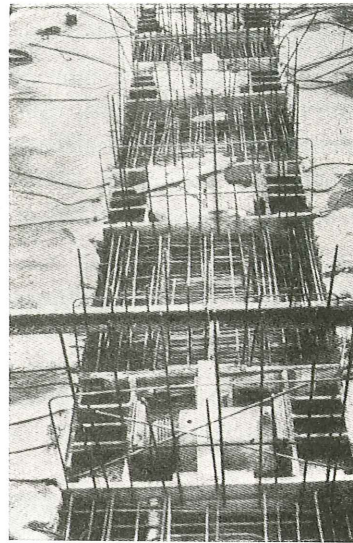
Puente de Liedbachtal. Detalle de la junta del tablero y de la disposición de los elementos de pretensado.
